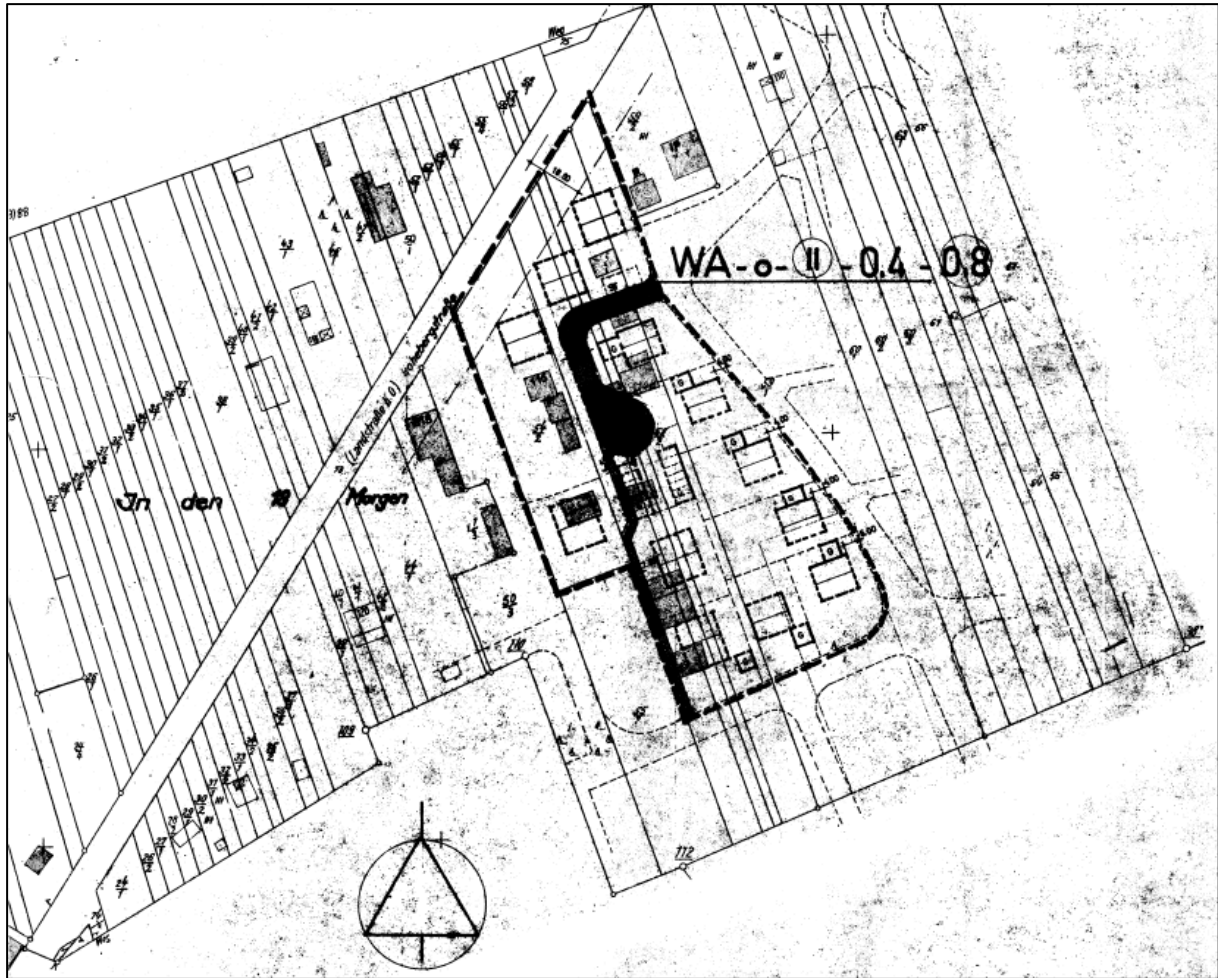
Bebauungsplan Nr. 9b Ergänzung und 2. Teiländerung für das Gebiet im Birkeneck
